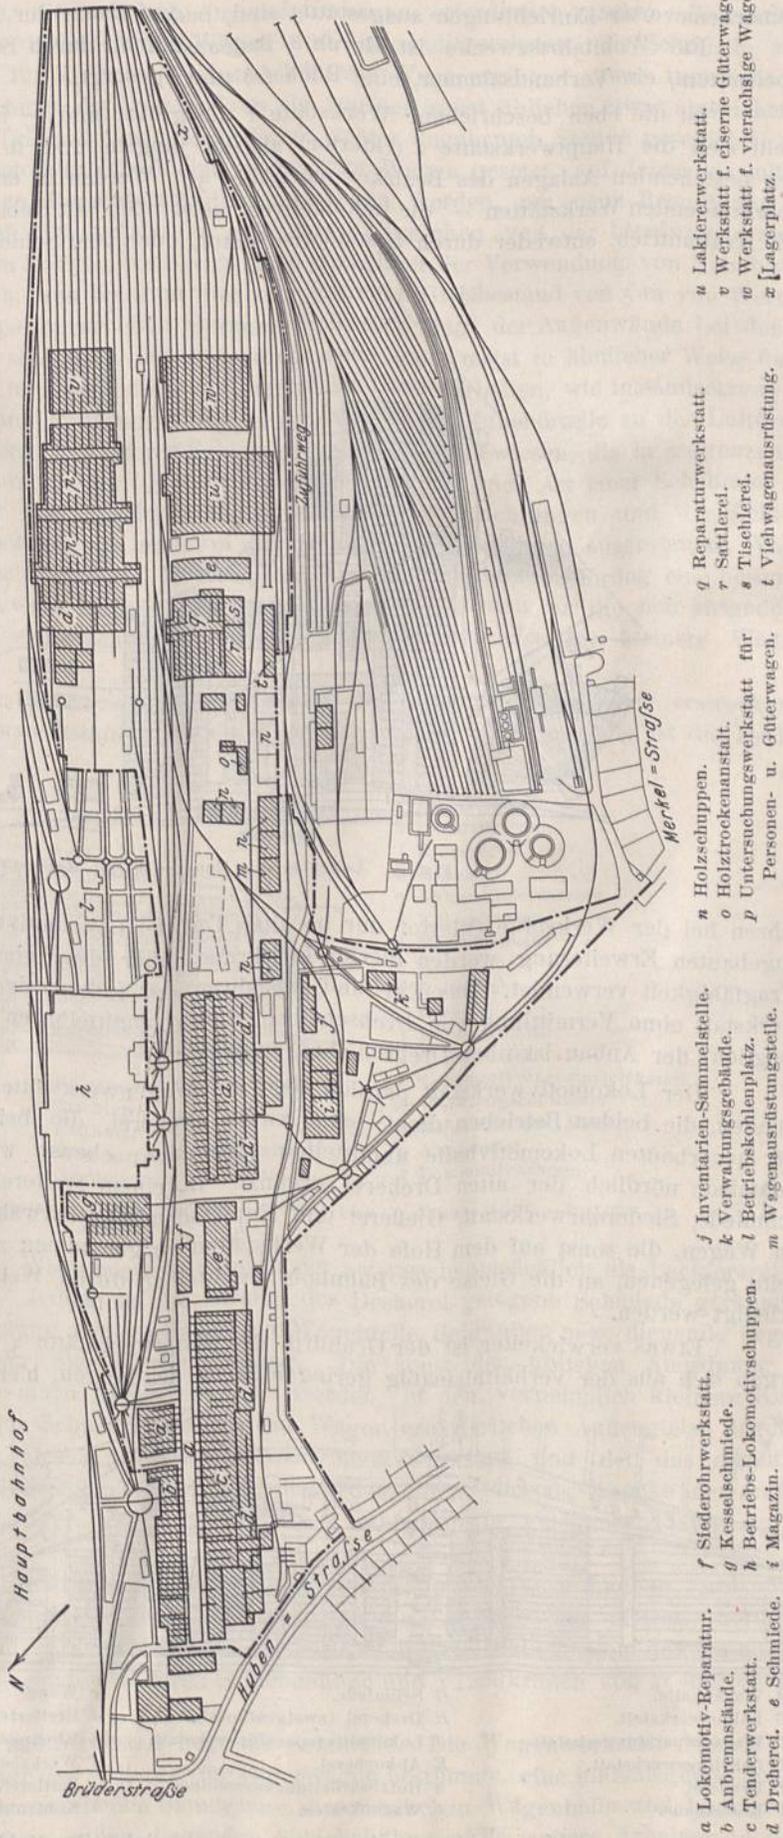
Lageplan der Hauptwerkstatt O/S. zu Breslau, 1 : 6000.
